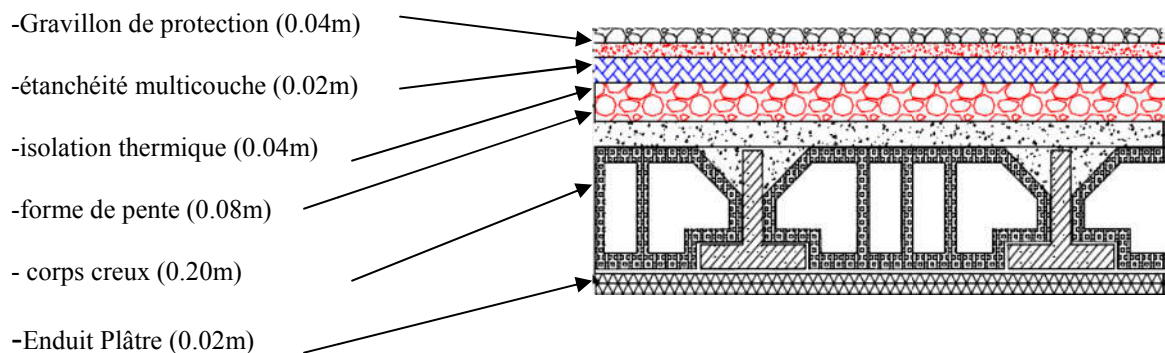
Schéma d'un plancher de terrasse inaccessible.
